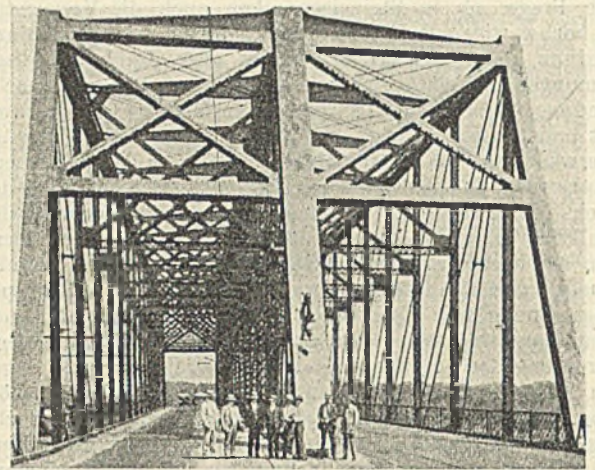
Stirnansicht der fertig umgebauten Brücke.
